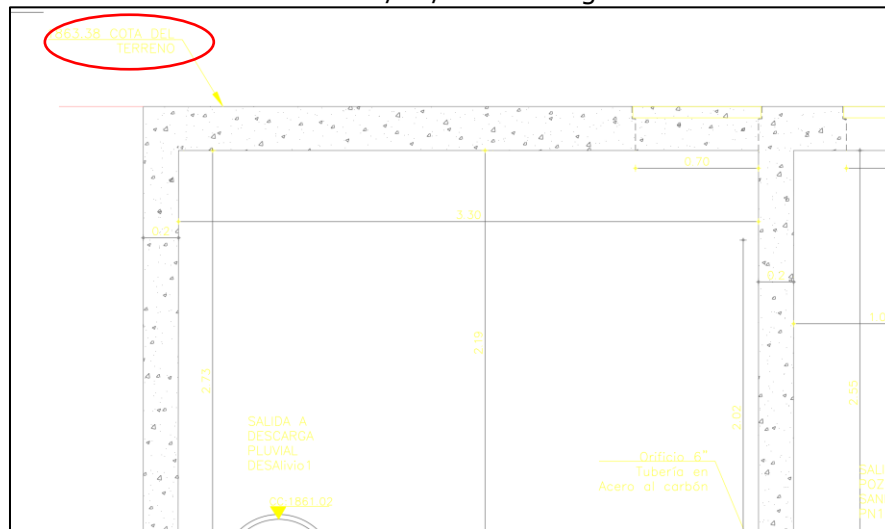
Plano detalle aliviadero. Fuente: Consultoría.
